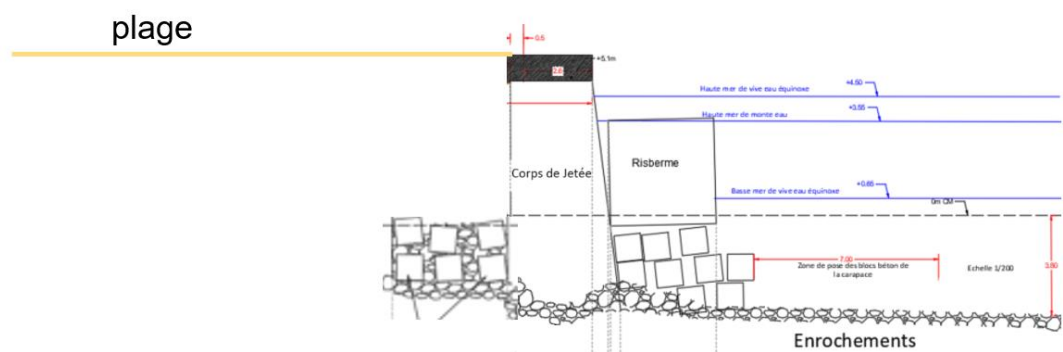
Plan de principe de coupe PM120 (section courante amont)
